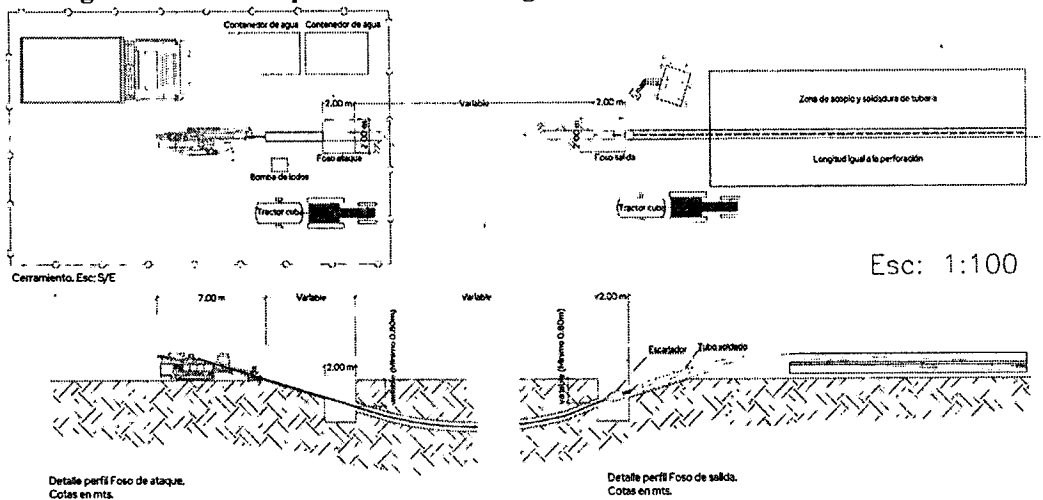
Detalle vista en planta y perfil de la Perforación Horizontal Dirigida (PHD) Fuente: RODAS SOLAR S.A.S, 2025
